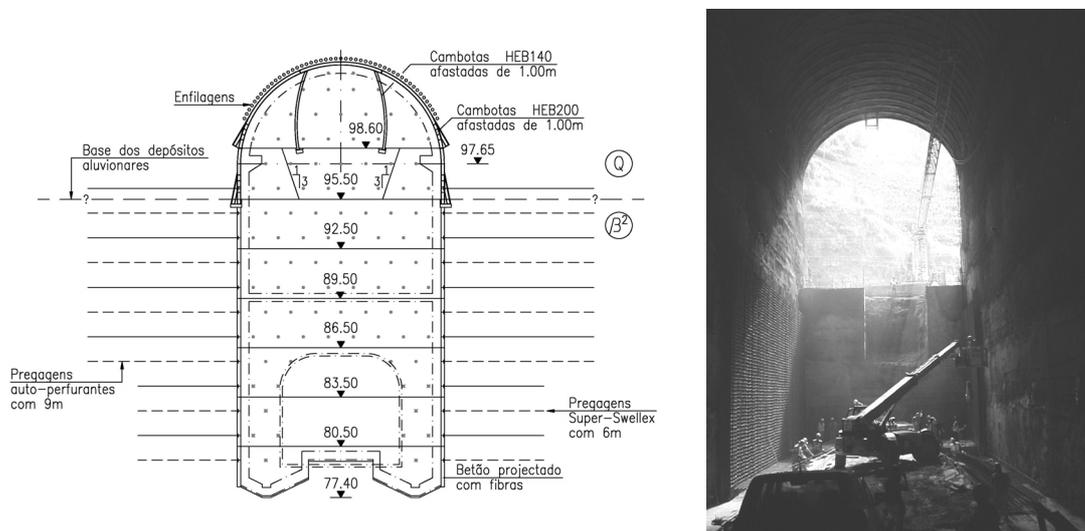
Faseamento executivo e sustimentos. Secção transversal da estação elevatória
